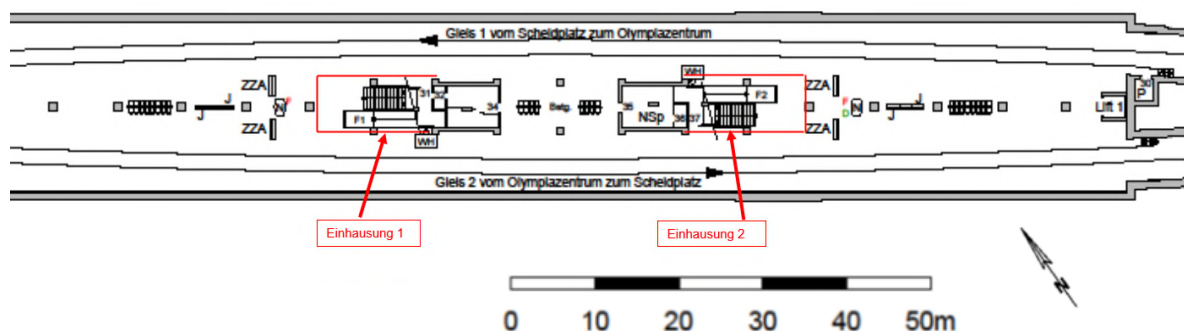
Grundriss Bahnsteiggeschoss, Einhausungen
